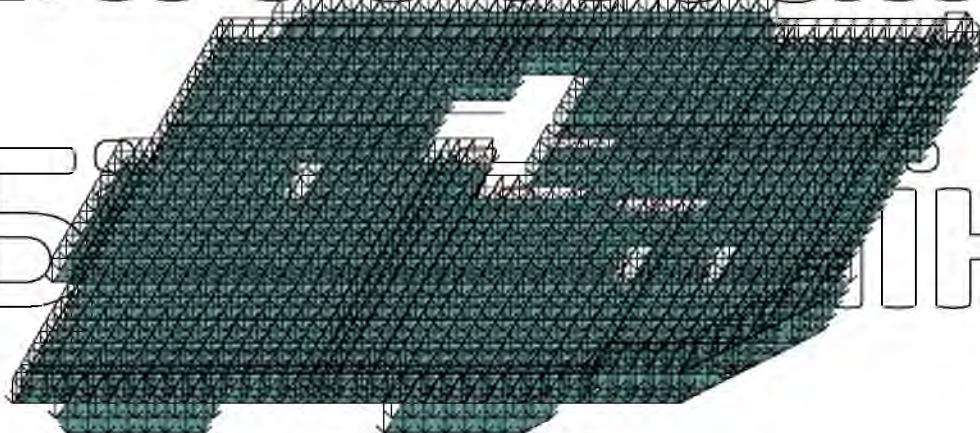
· Навантаження на циліндр перекриття типового поверху
